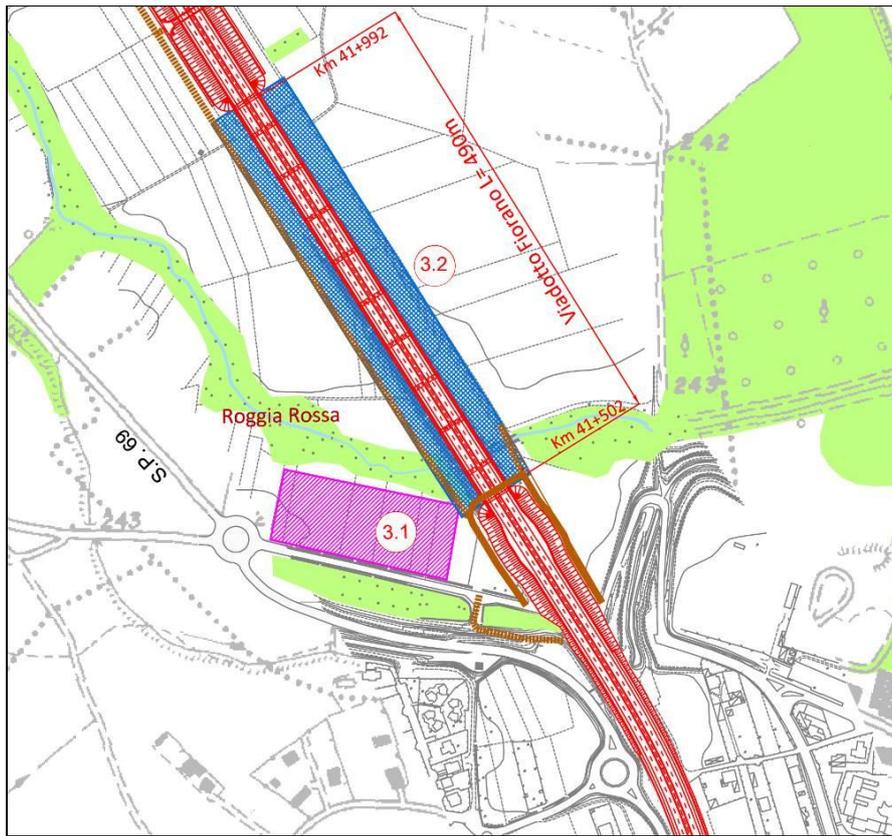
/15 Localizzazione del cantiere di base 3.1 e del cantiere viadotto 3.2
